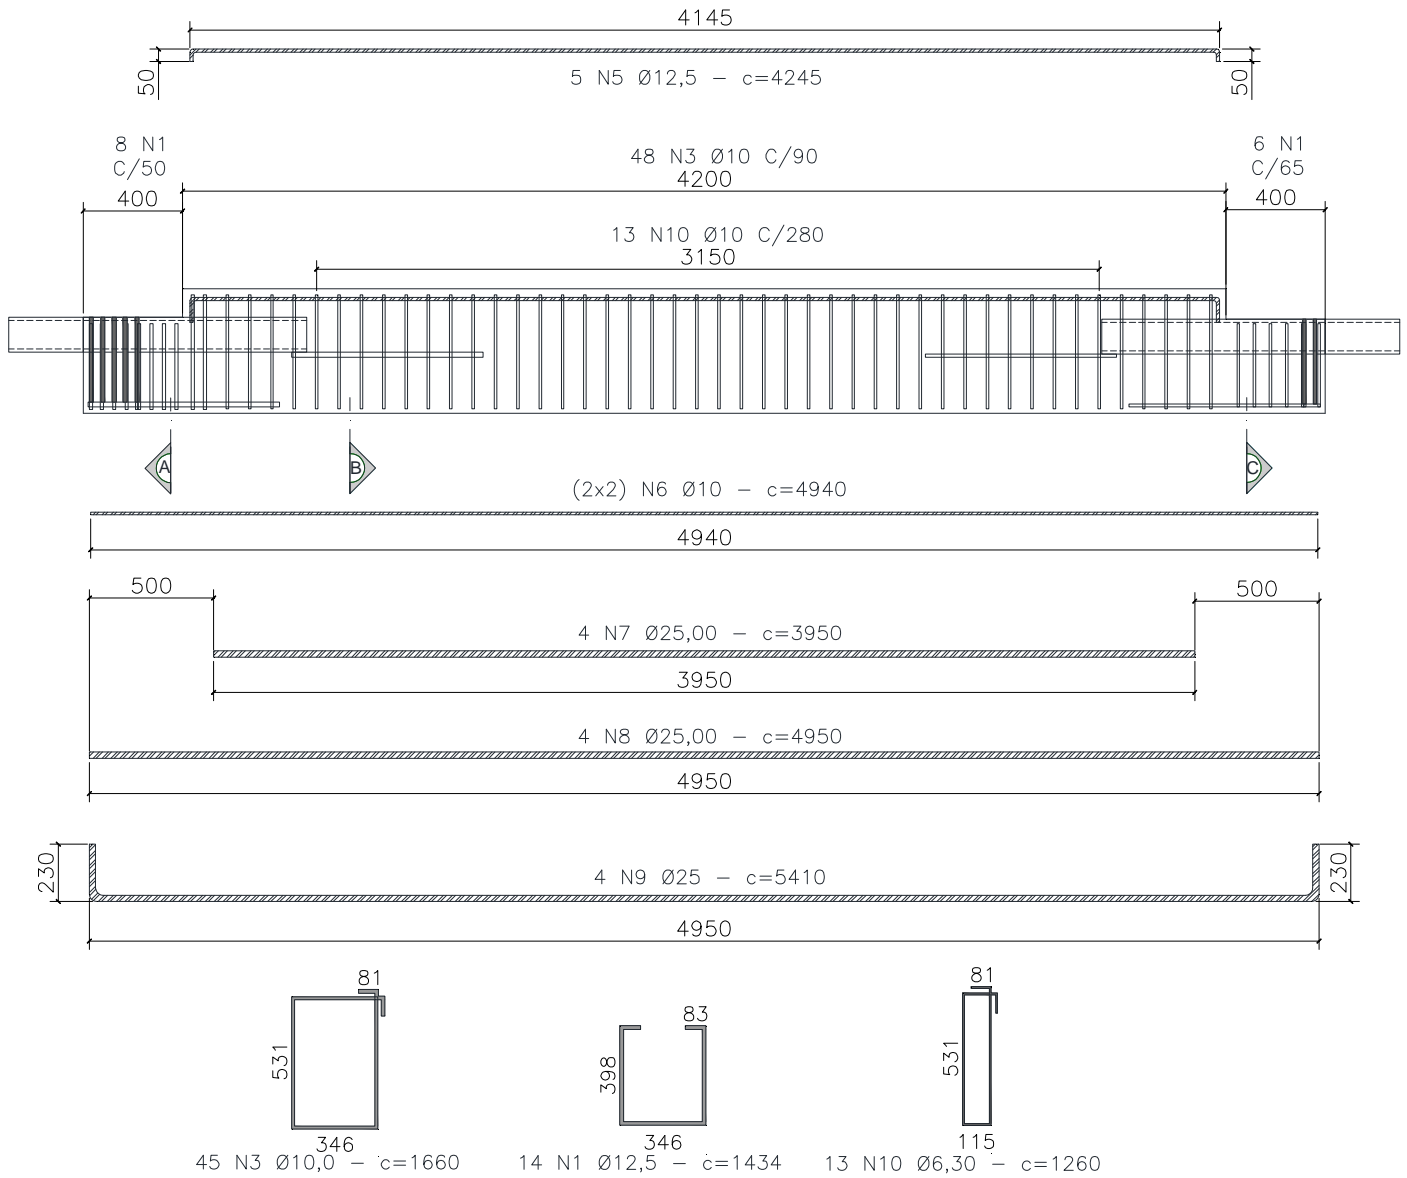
Armadura da viga pré-moldada – Parte I.
